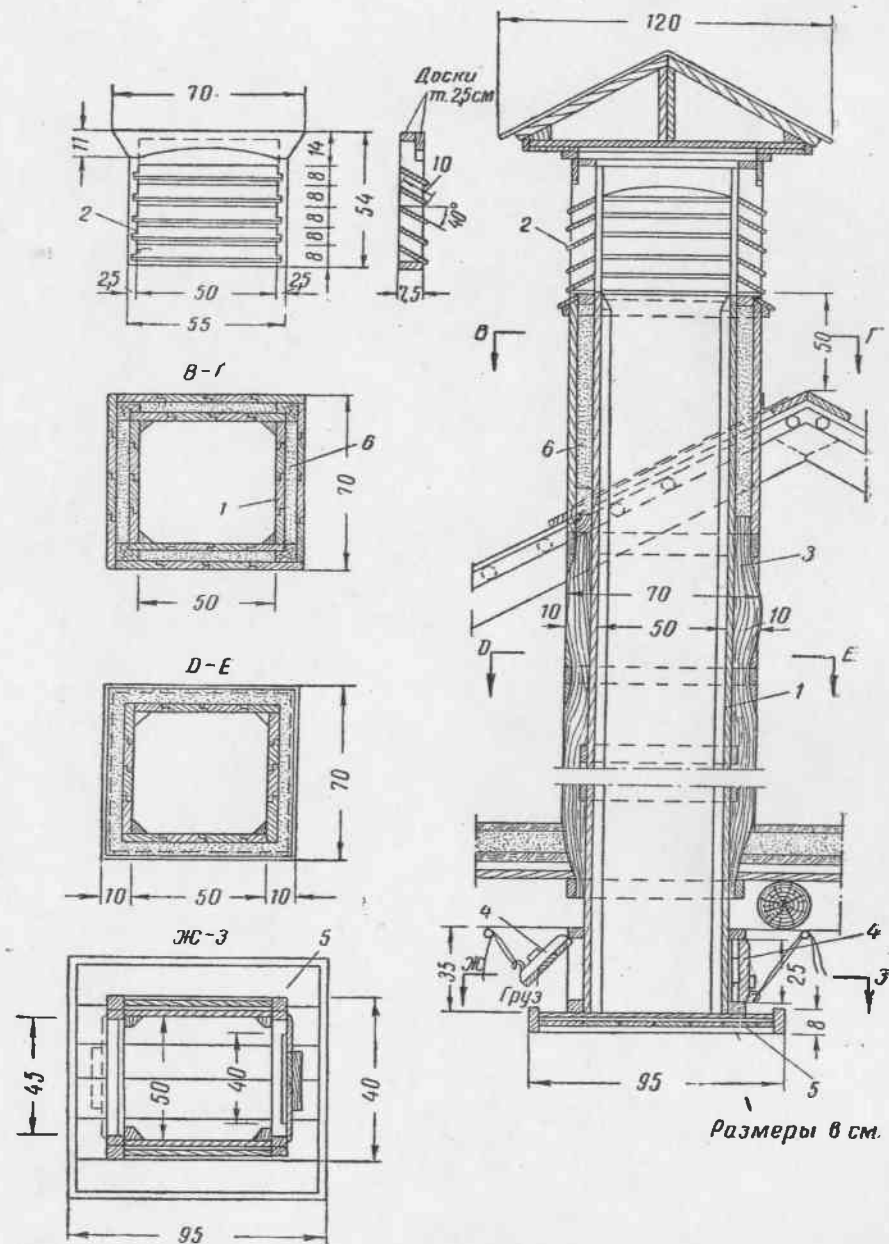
Вытяжной вентиляционный канал (общий вид, планы и разрез). 1—короб из досок толщиной 2,5 см; 2—жалюзи; 3—соломенные маты; 4—откидные клапаны; 5—щит из двух слоев досок с прокладкой толя; 6—утепляющая засыпка.
